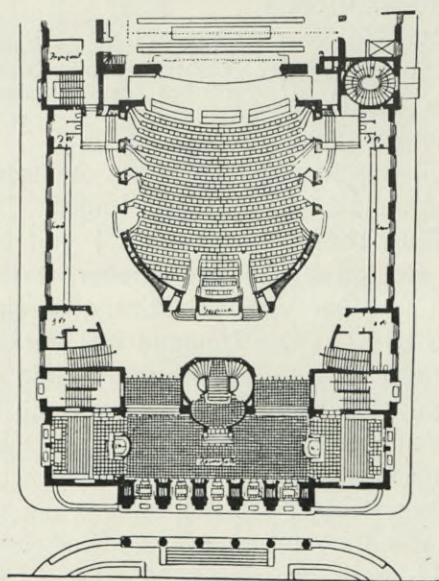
Hoftheater zu Weimar. Grundriß des Zuschauerhauses im Erdgeschoß.
